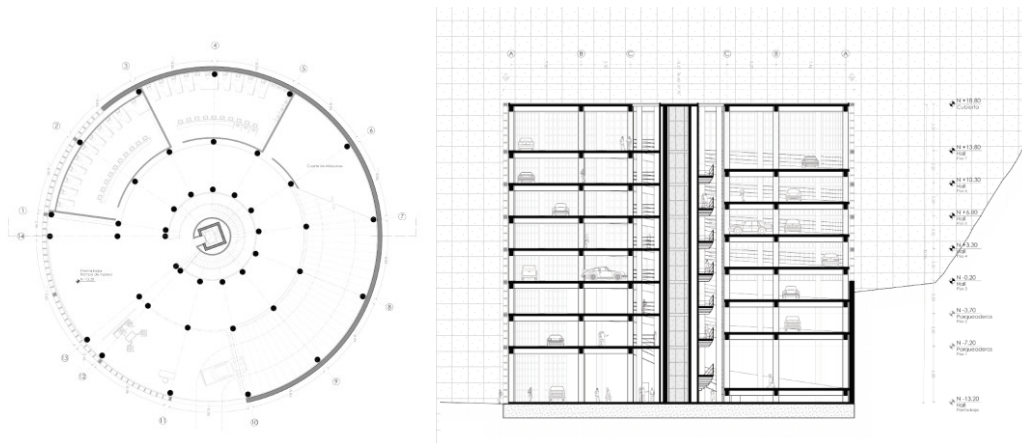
Relación entre planta baja, subsuelo y sección de la torre de aparcamiento e ingreso (Buenaño, 2020)
